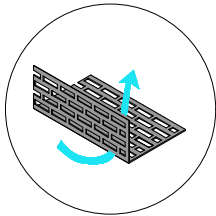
offene horizontale Fuge mit vertikaler Fuge
